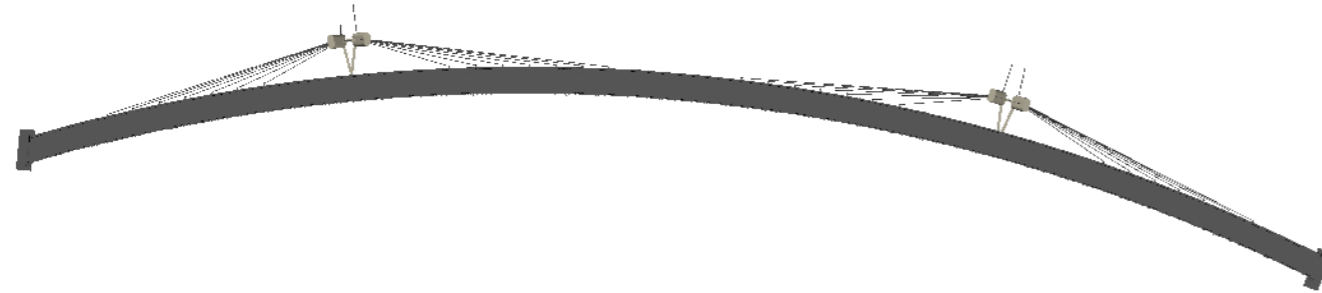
Vista en planta de la pasarela. Fuente: Elaboración propia.
